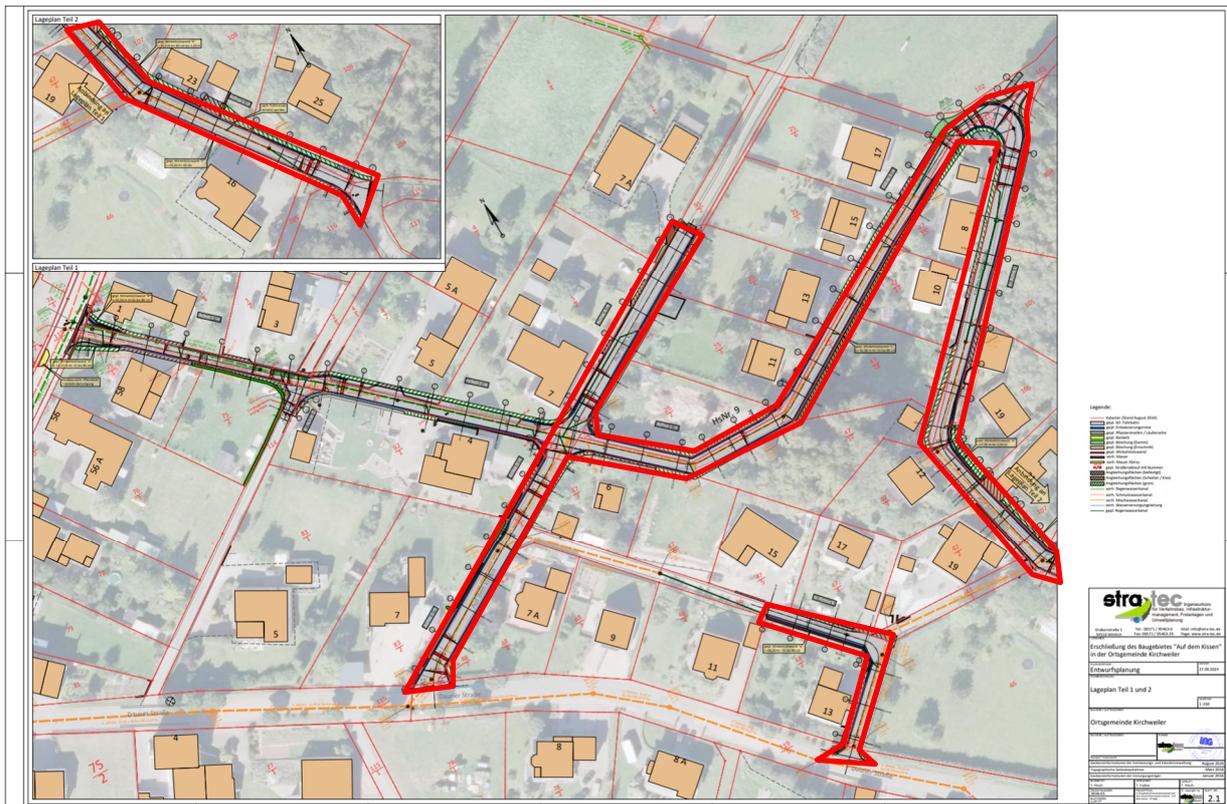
Straßenplanung, Stratec, Wittlich, Kennzeichnung der ersten Bauabschnitte
